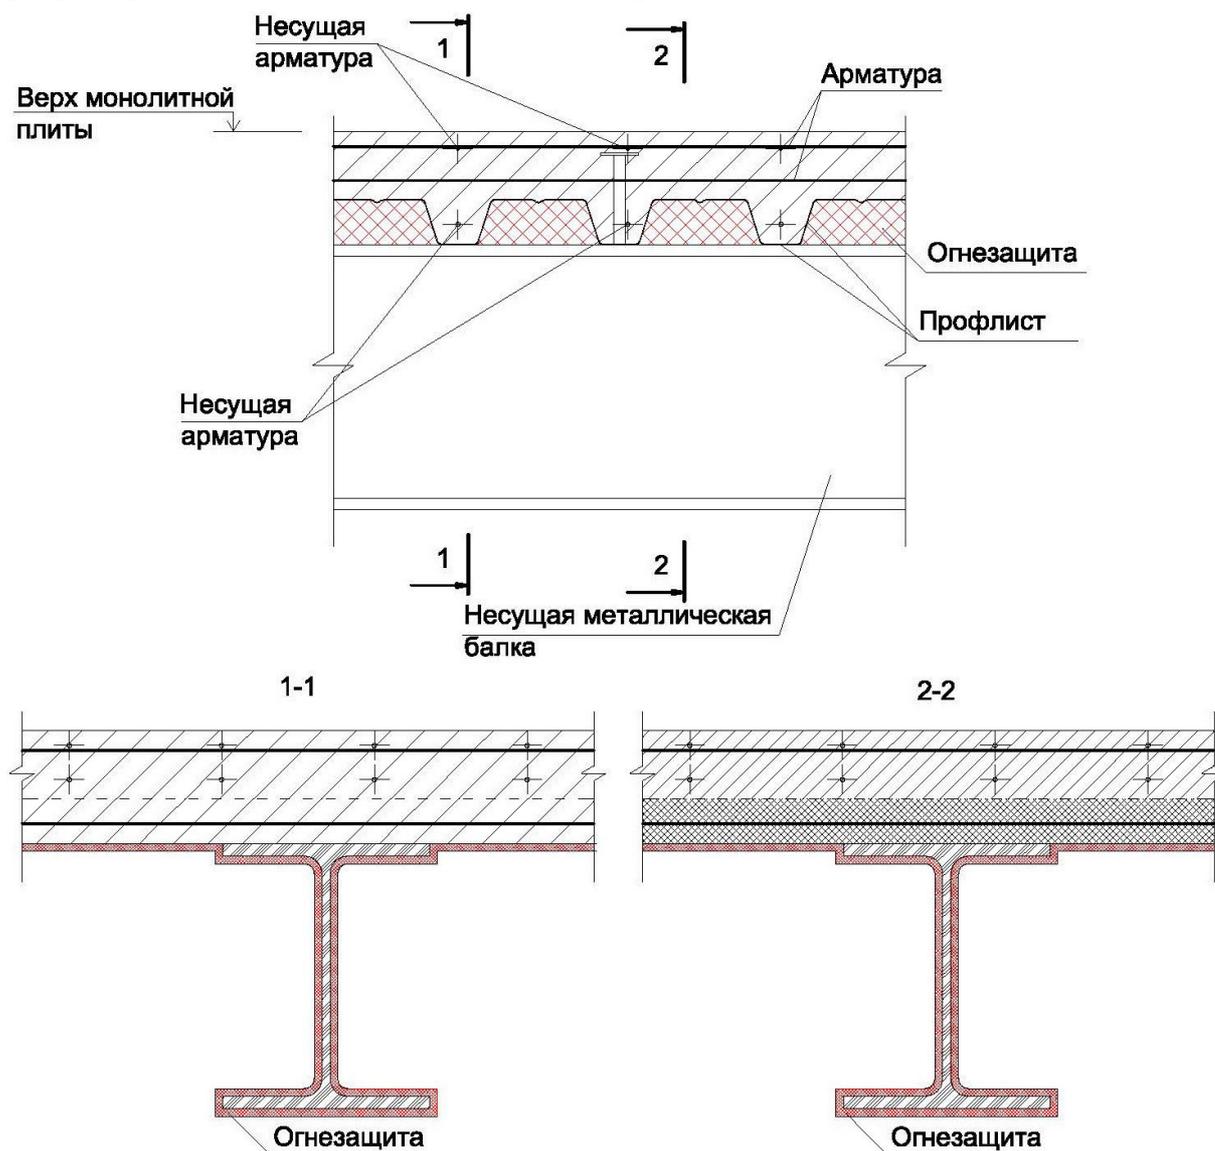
Пример огнезащиты двутавровой балки перекрытия
